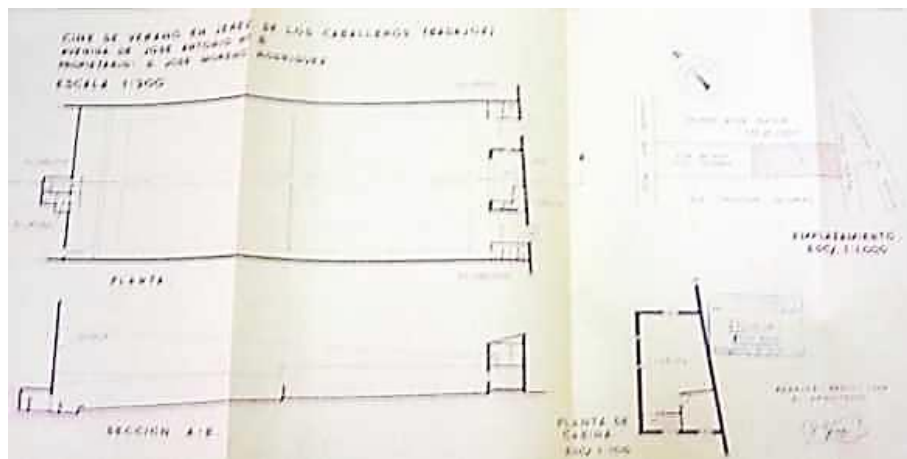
Planos de planta, sección, situación y cabina del Cine de verano Balboa (GÓMEZ ÁLVAREZ, P., 1964).
